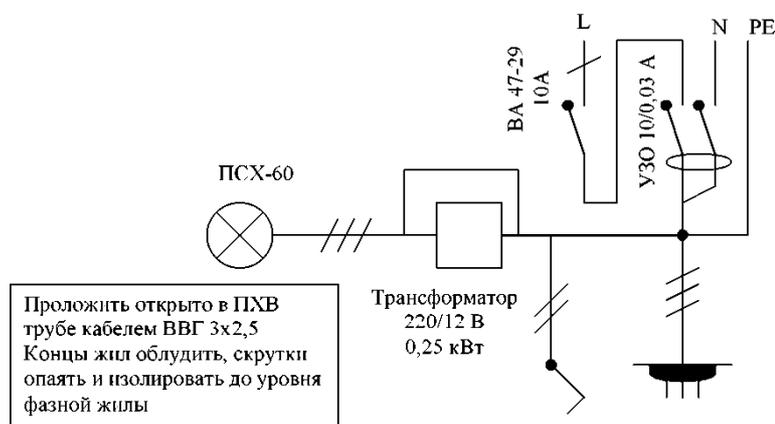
Монтажная схема электропроводки в сырых и влажных помещениях
